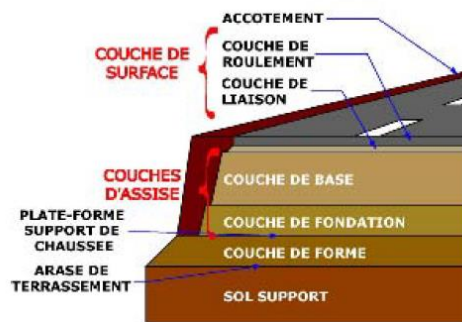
Profil type d'une chaussée (Nguyen 2008)
